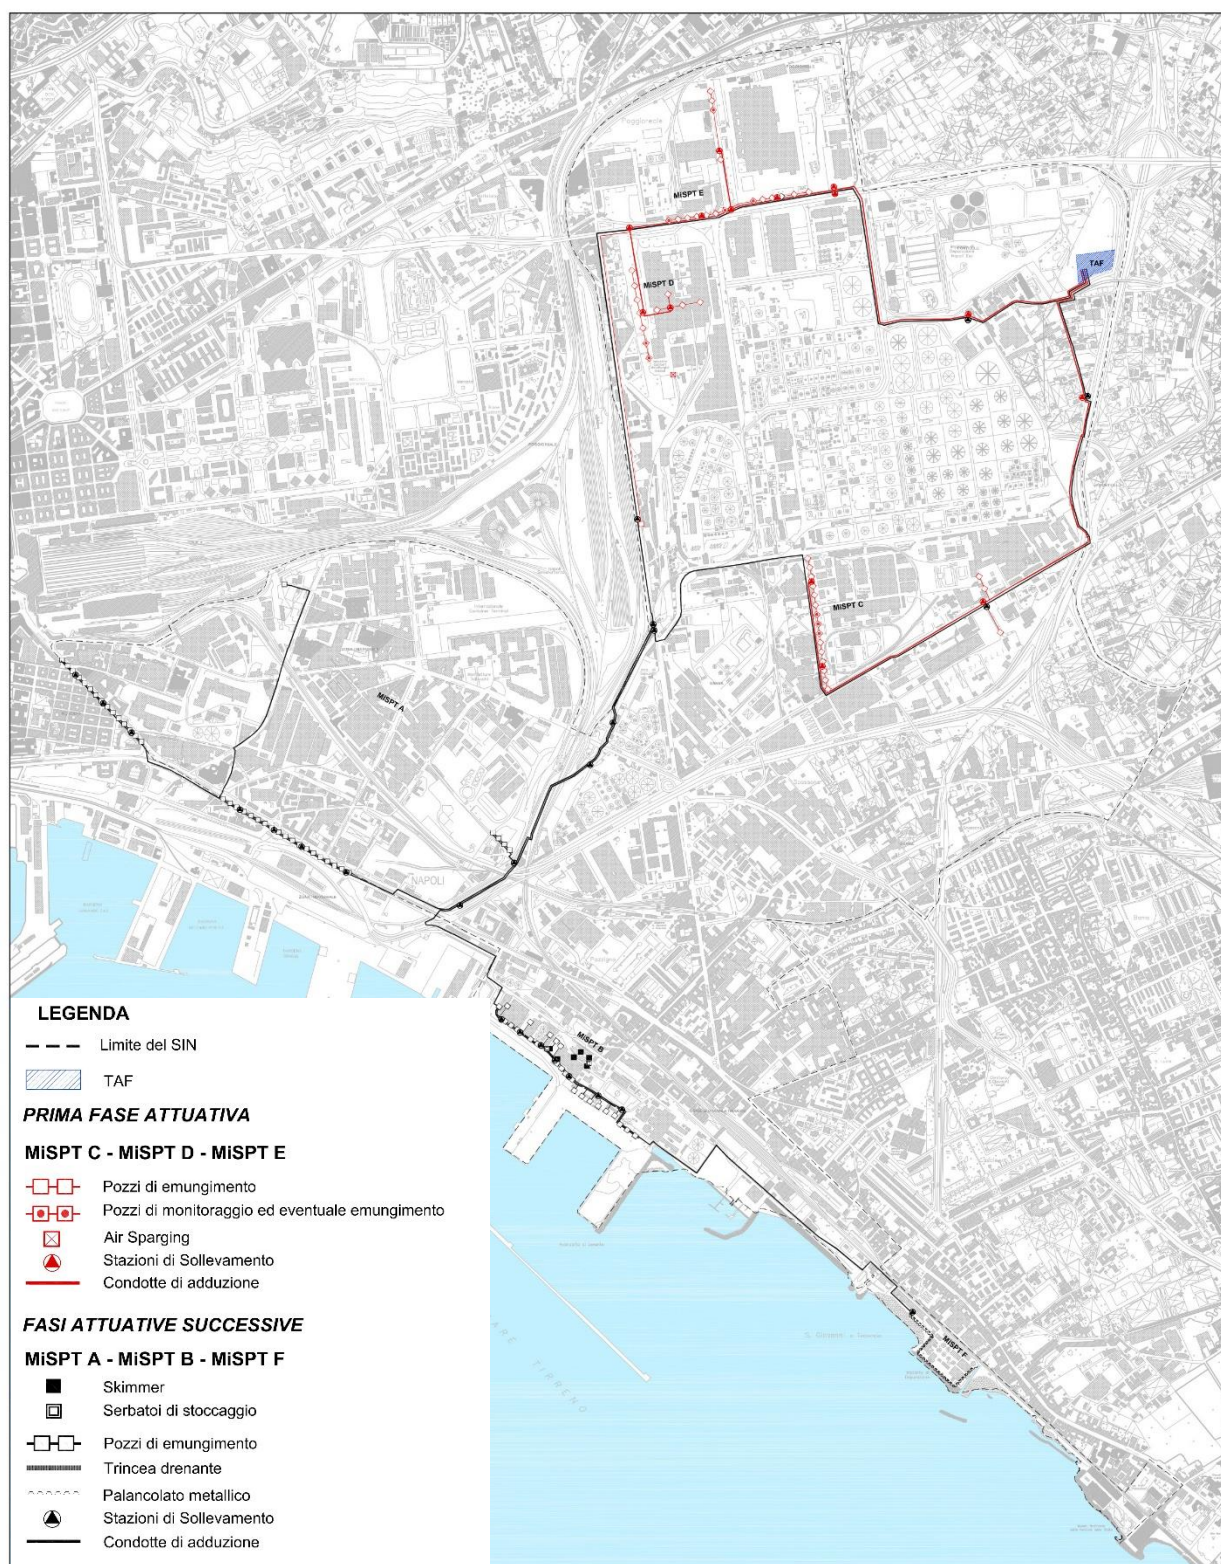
Planimetria degli interventi previsti in progetto.
